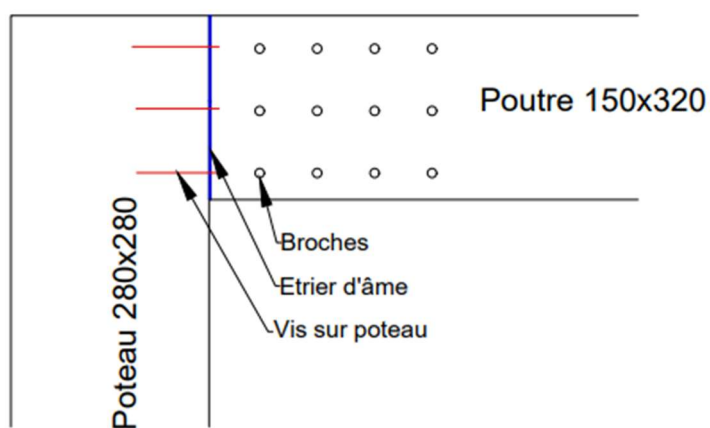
ASSEMBLAGE POUTRE TOITURE/ POTEAU/ VIGIE
